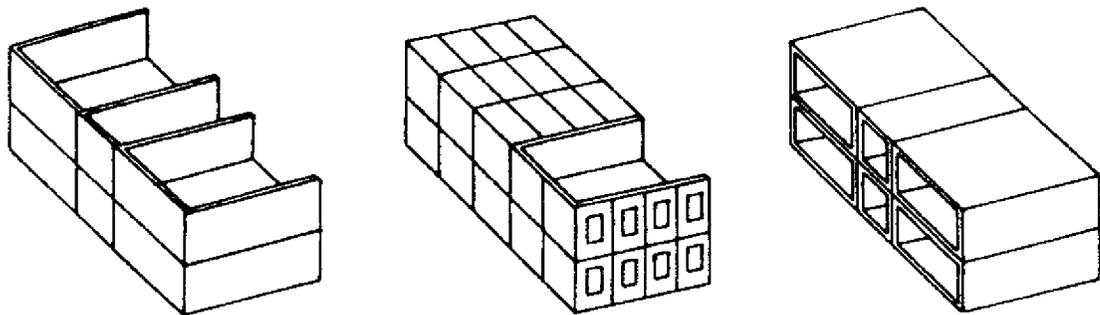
Sistema de paneles precolados (Wakabayashi, 1986).
